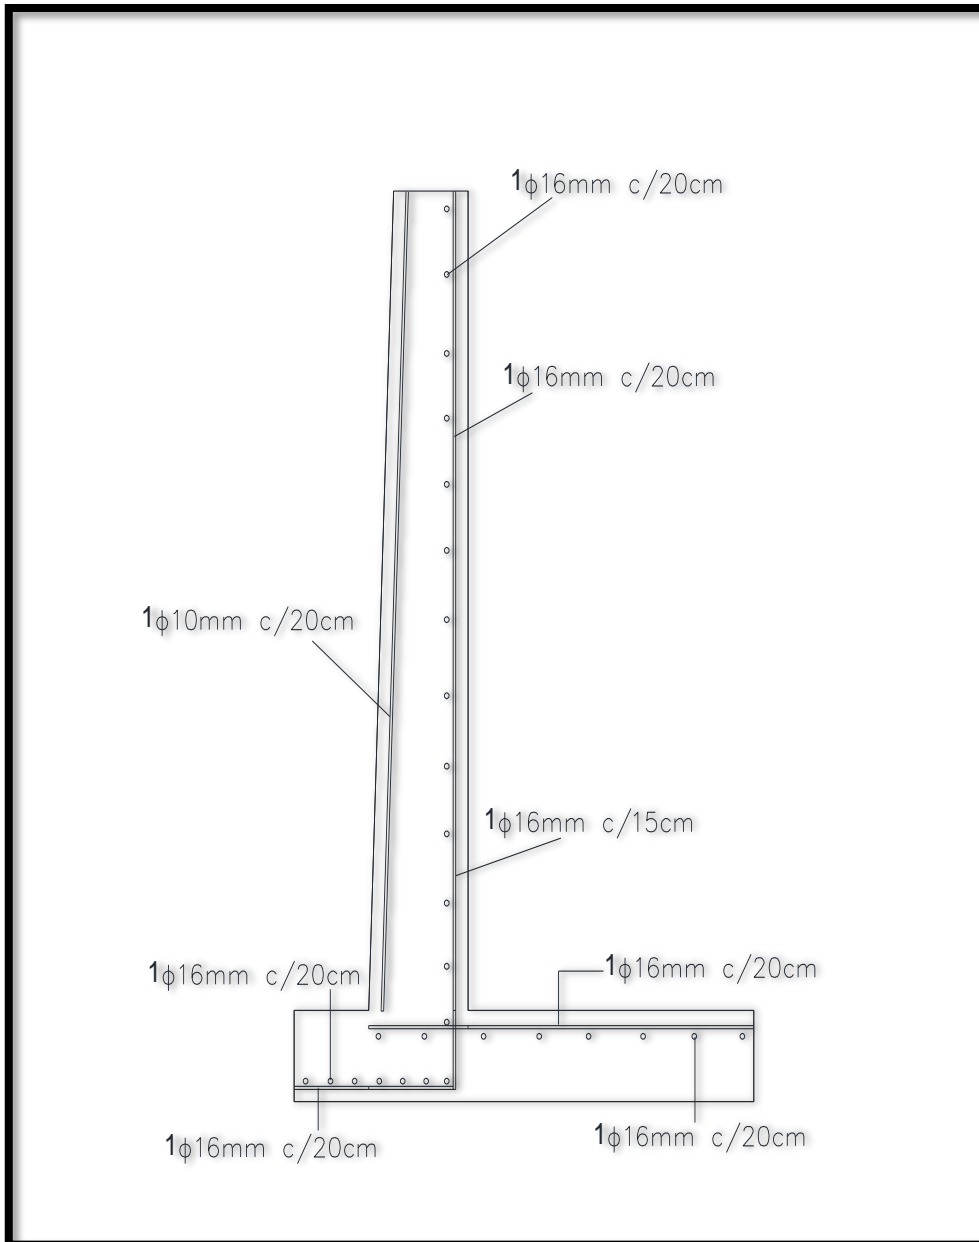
Esquema de armaduras del muro de sostenimiento (fuente: elaboración propia).
